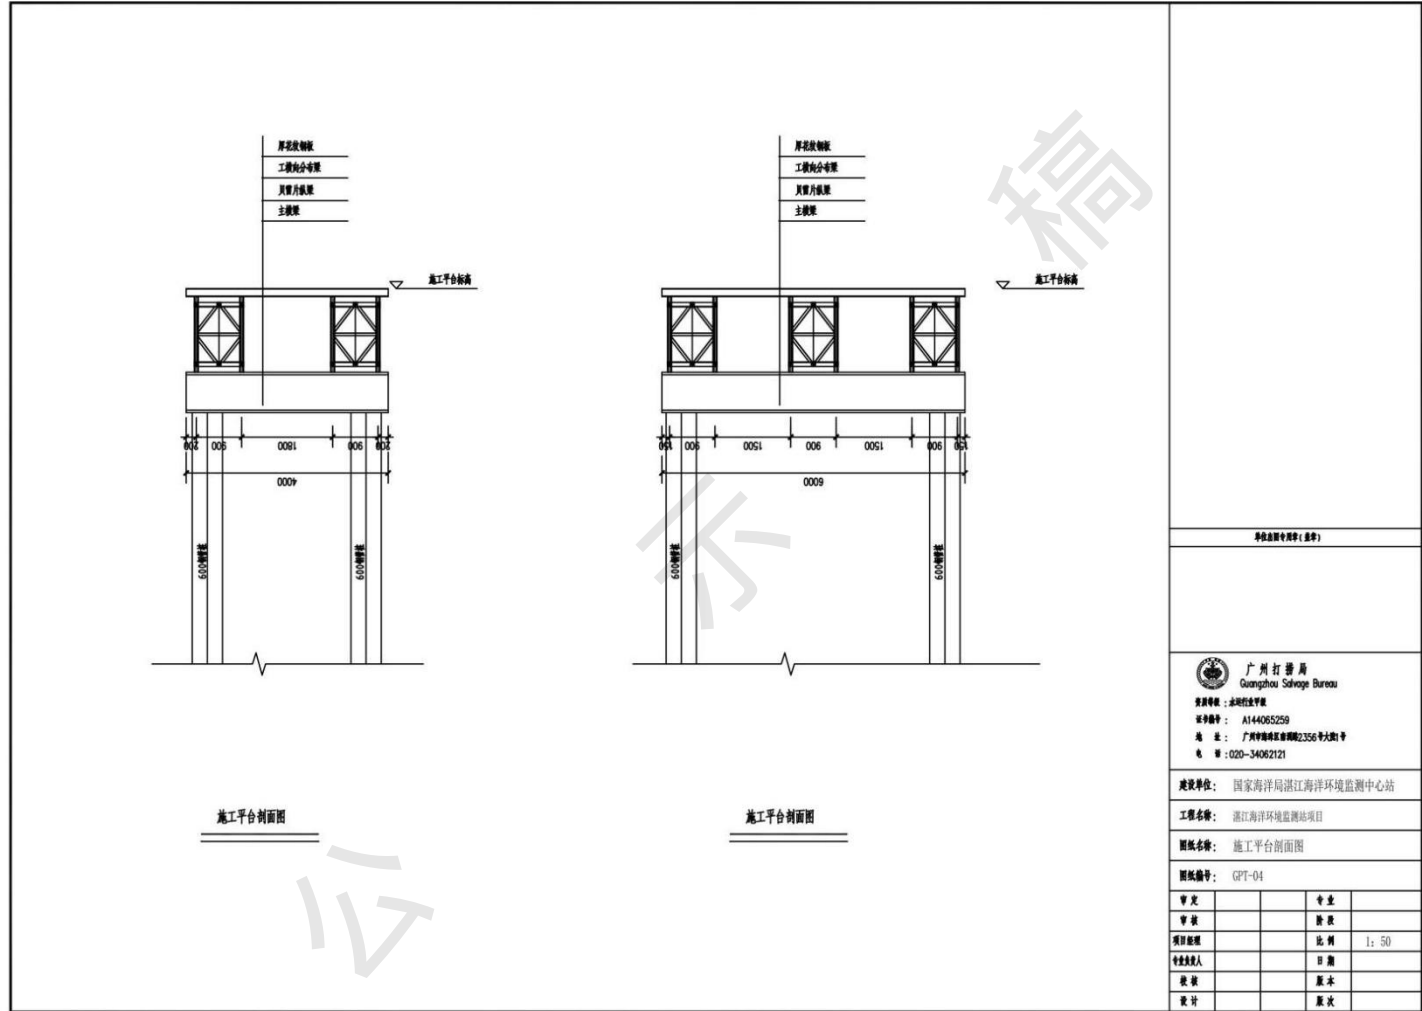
施工平台B-B（左侧）和C-C（右侧）剖面图
